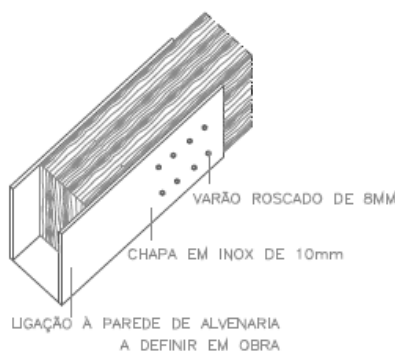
Reforço com elemento metálico preconizado para apoio degradado [36]
